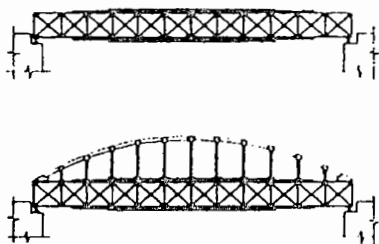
Arco superior como reforço de ponte em viga treliçada simplesmente apoiada
